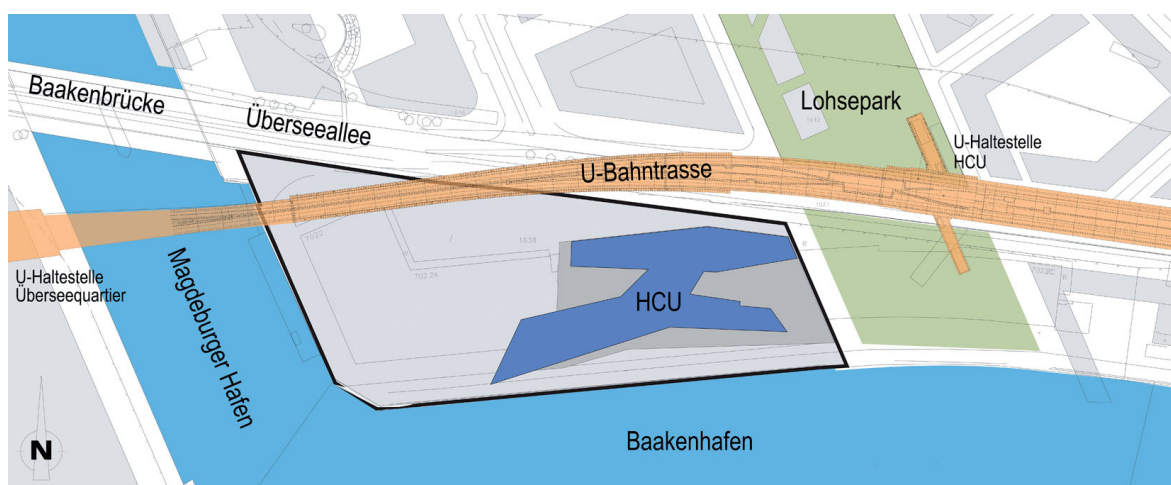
Lageplan Neubau HCU mit U-Bahntrasse
